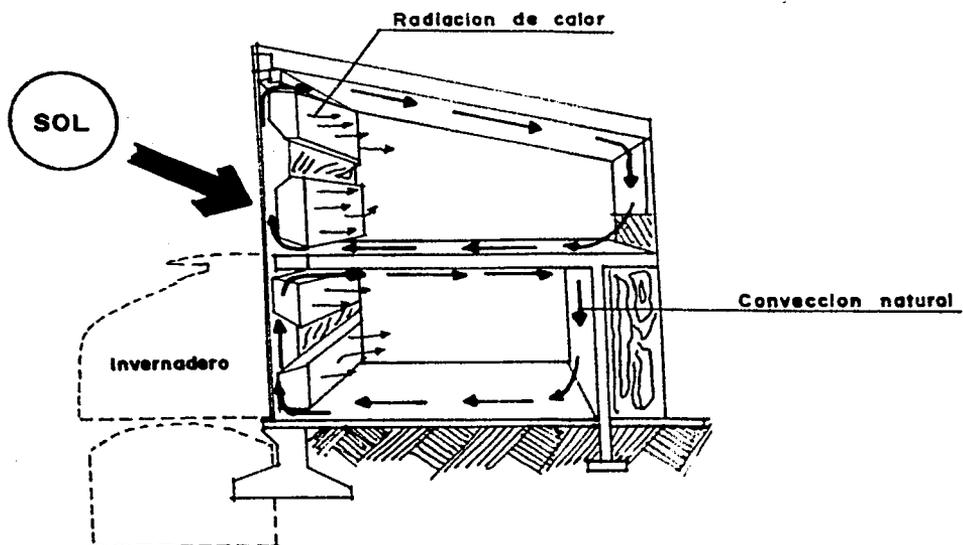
Seccion de la casa Kelbaugh en Princeton.
